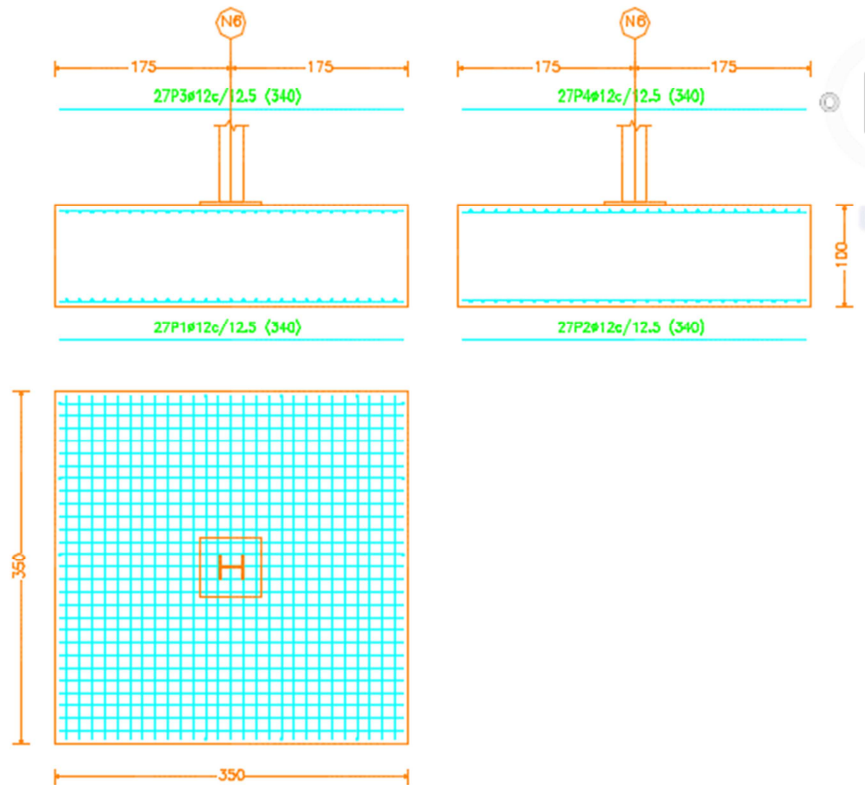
Detalle de la cimentación de los pilares centrales de pórticos de fachada
